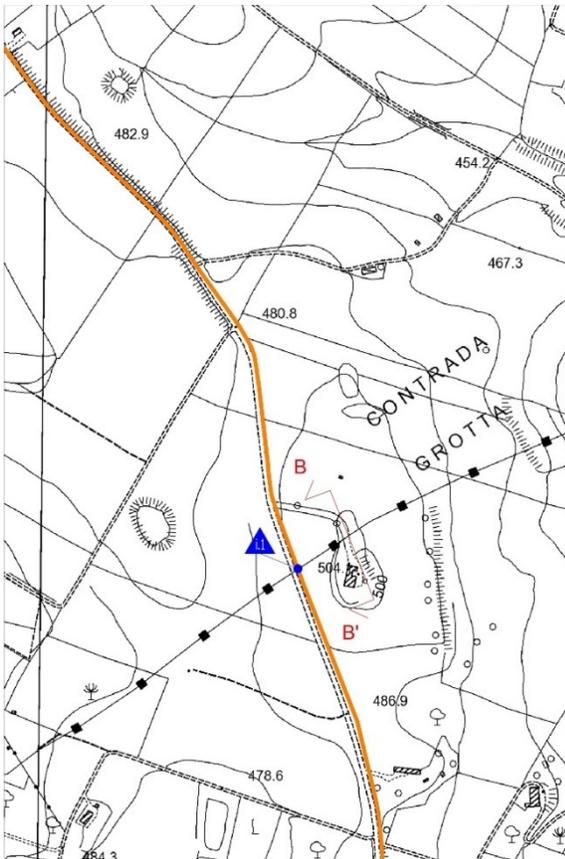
Tracciato cavidotto MT di collegamento alla SSE
